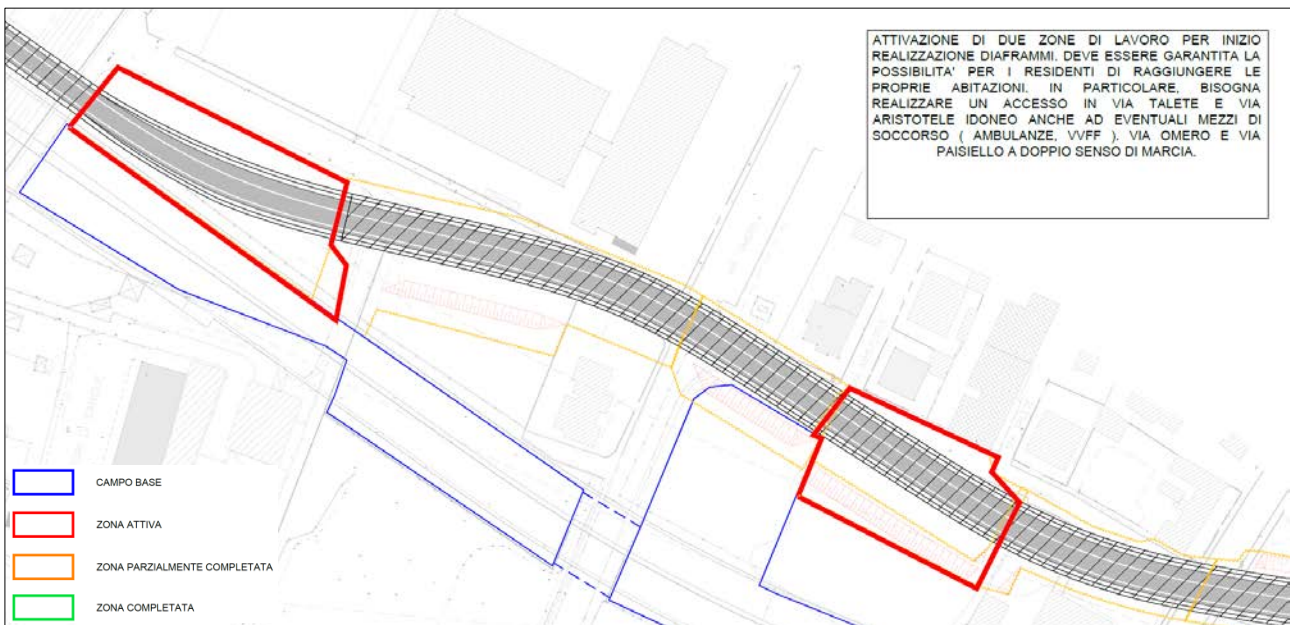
Fasi realizzazione copertura galleria del Piano di Sicurezza di progetto illustrativo della fase B di scavo della galleria
